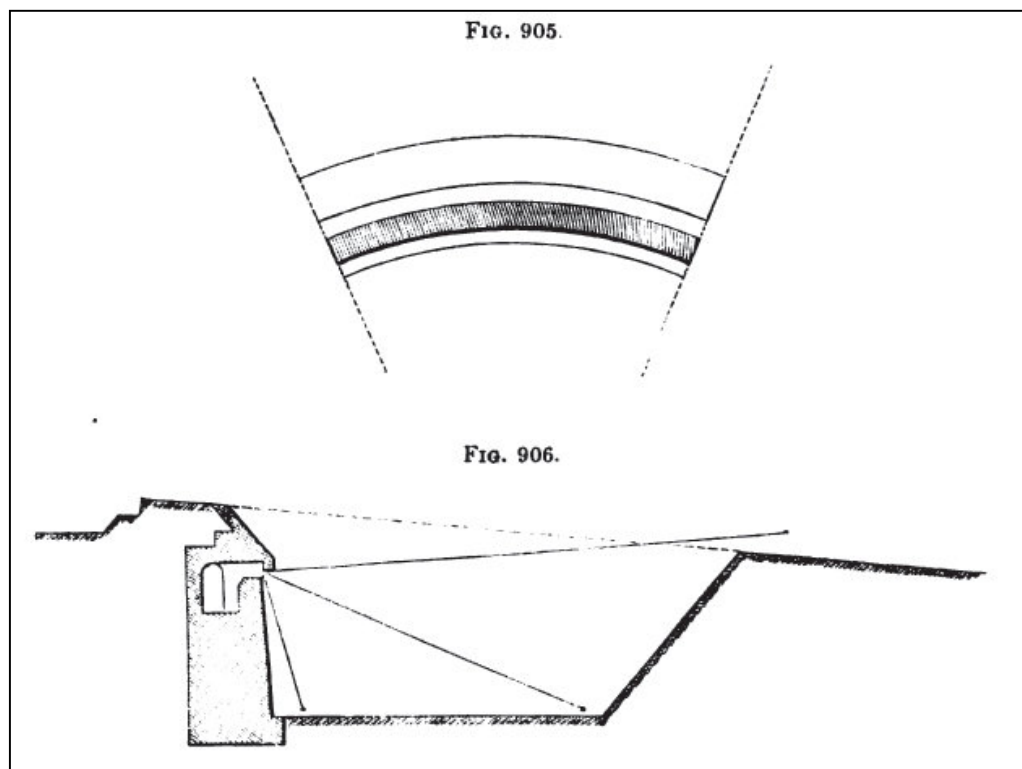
Escola Francesa – Cygnot. Planta de Fortificação e Perfil. Ibidem, pág.526.
